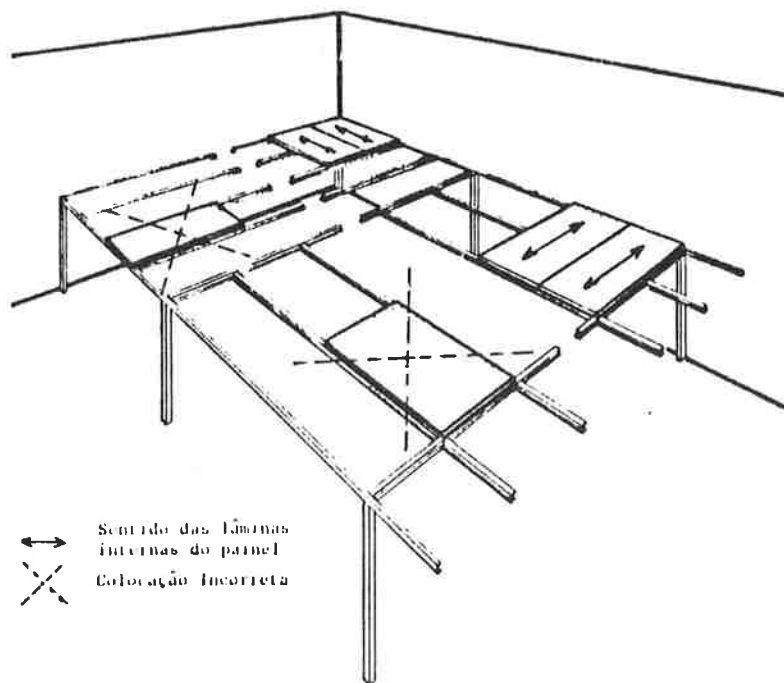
Estruturação e colocação dos painéis compostos de madeira e fibrocimento.
